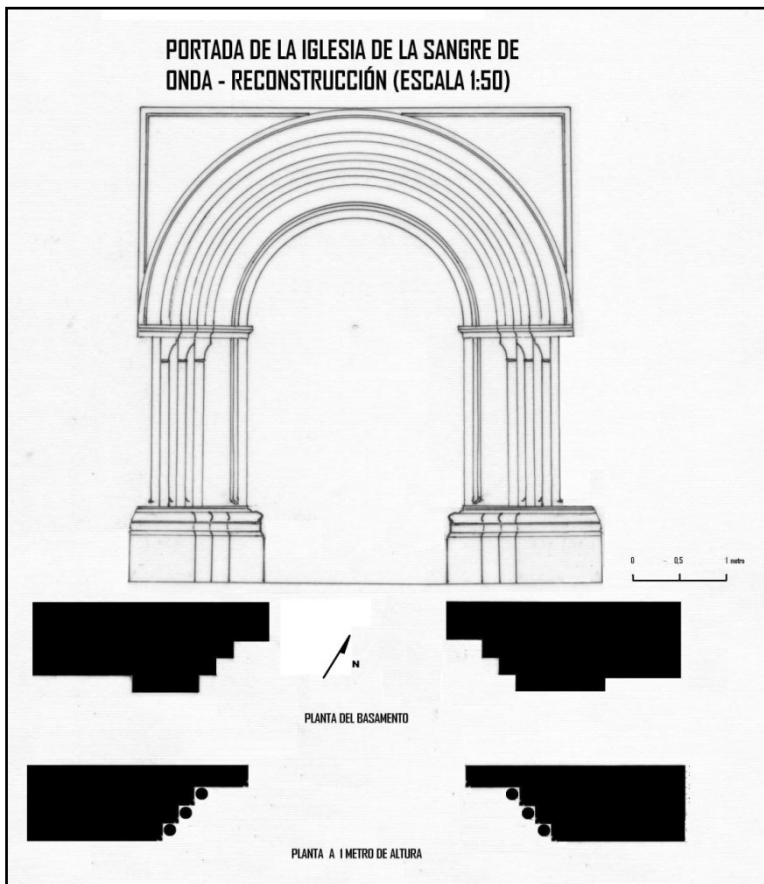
Diseño reconstructivo de la portada en alzado y planta ( F. J. Soriano)
